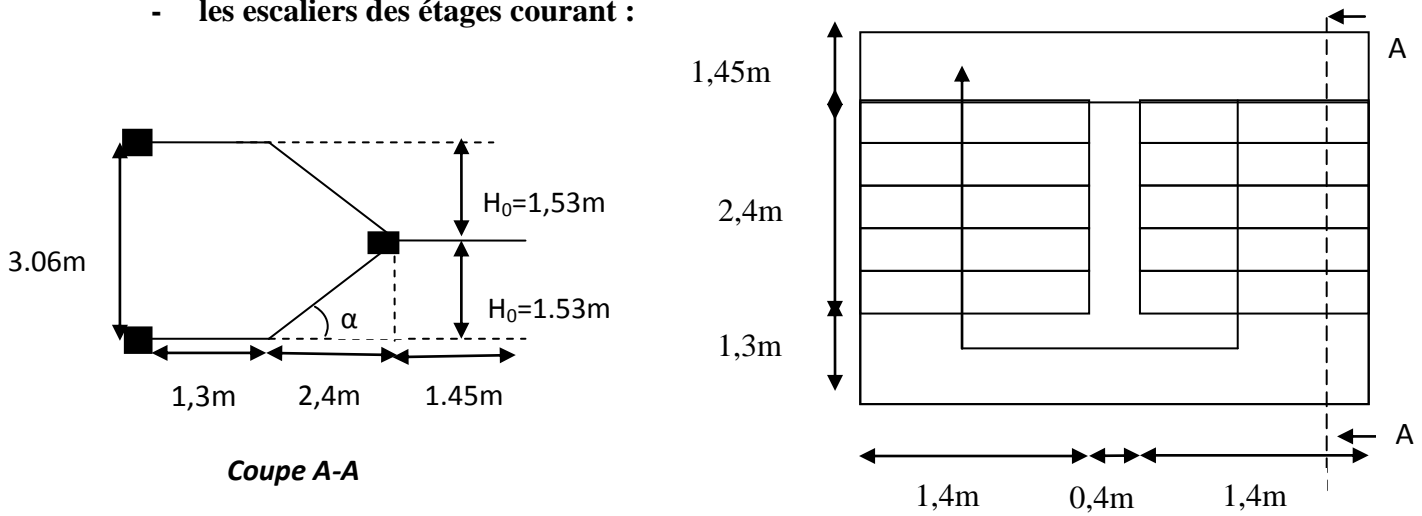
Vue en plan du 1^{er} type d'escalier (EC)
